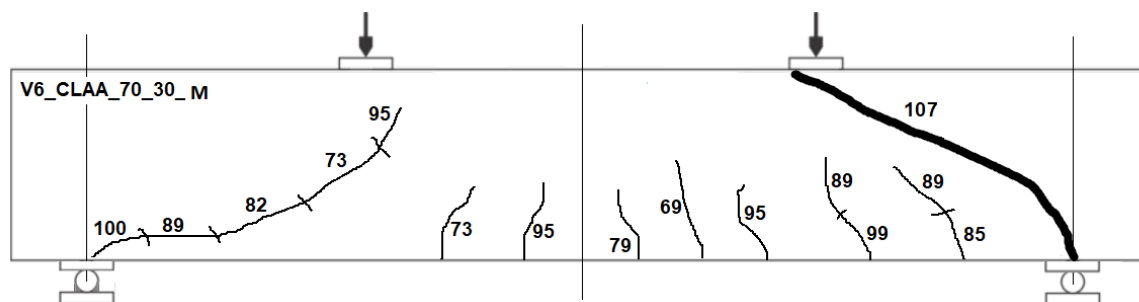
Esquema de fissuração da Viga 6_CLAA_70_30_M.
